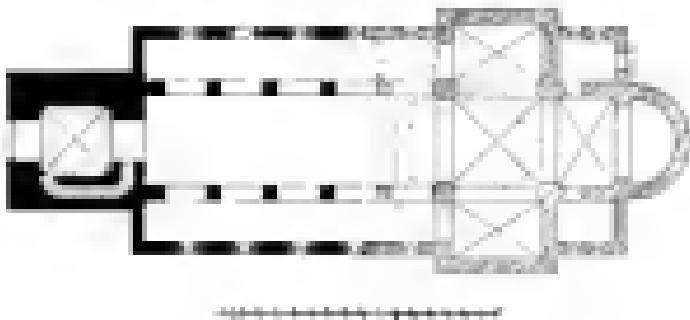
Oberpfalz: Grundriss der katholischen Pfarrkirche nach
